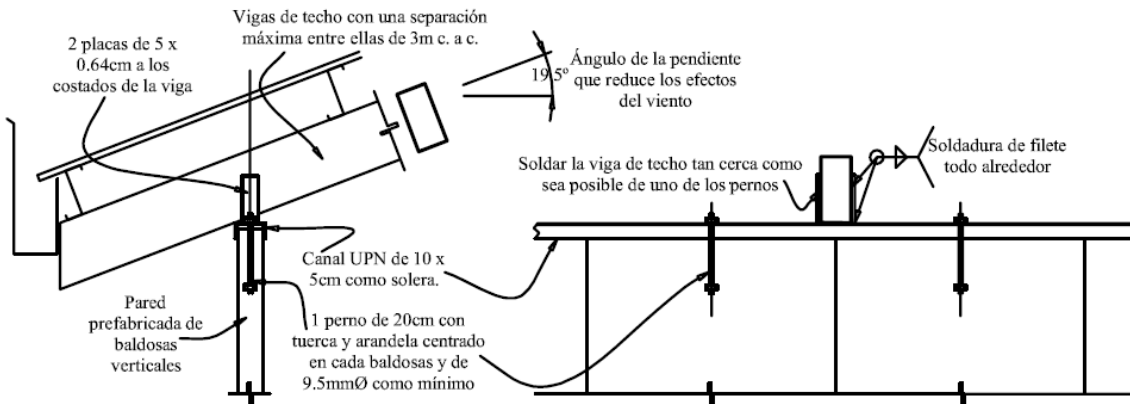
Detalle de apoyo de cercha en pared delgada a doble forro
